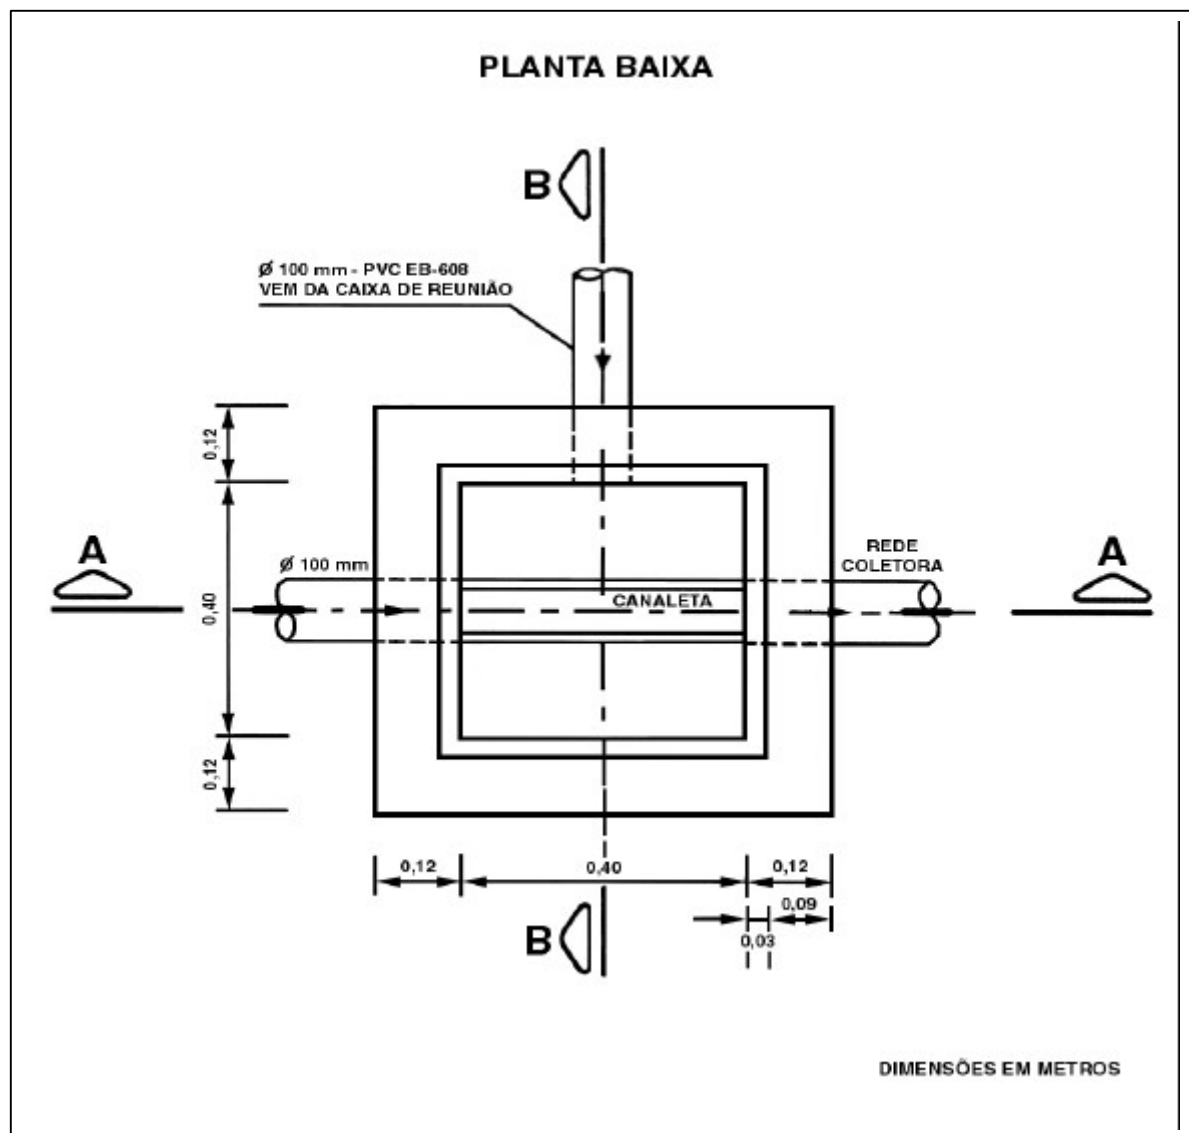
Caixa de Passagem CP 40- 60 – Planta
